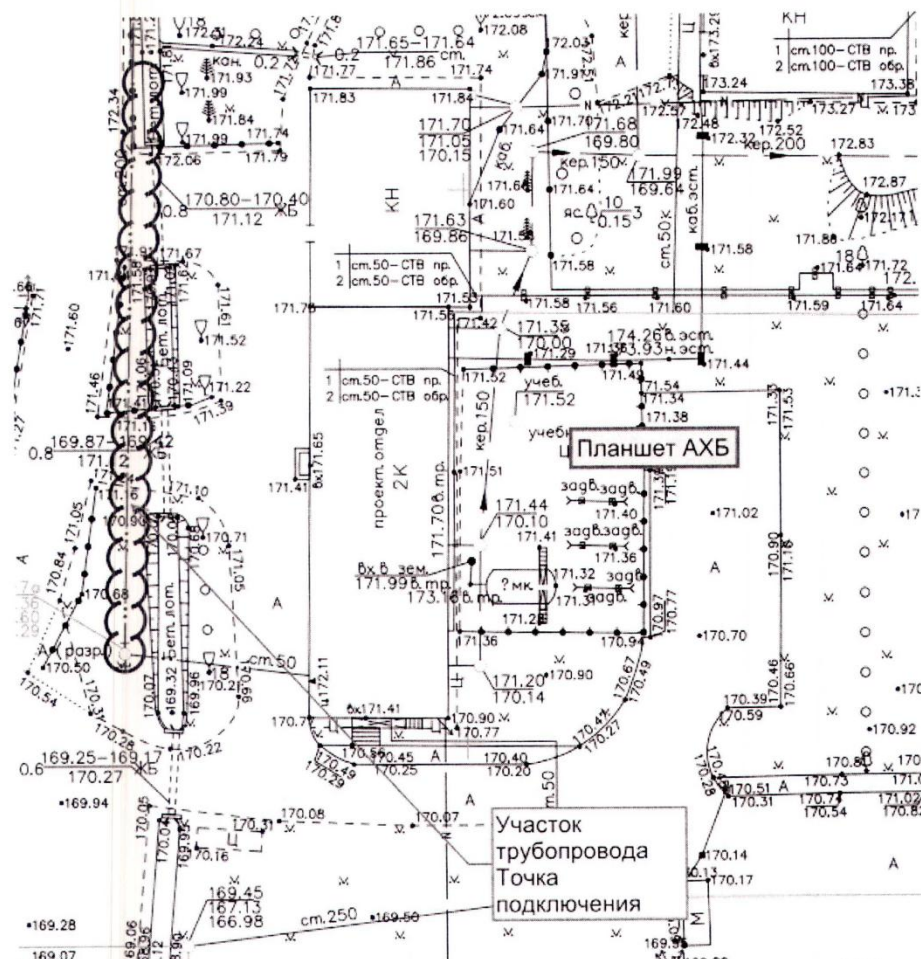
Схема подключения сетей к противопожарному водопроводу на планшете АХБ.
